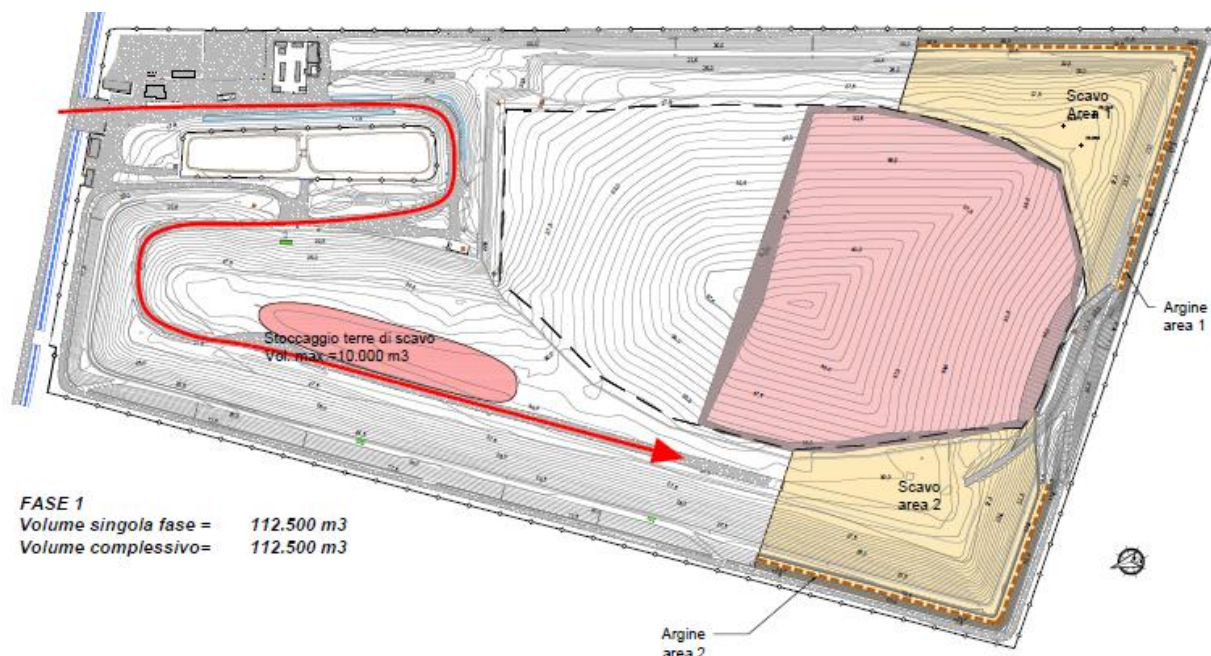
Planimetria relativa alla Fase 1 - Tavola 3.4 del progetto
